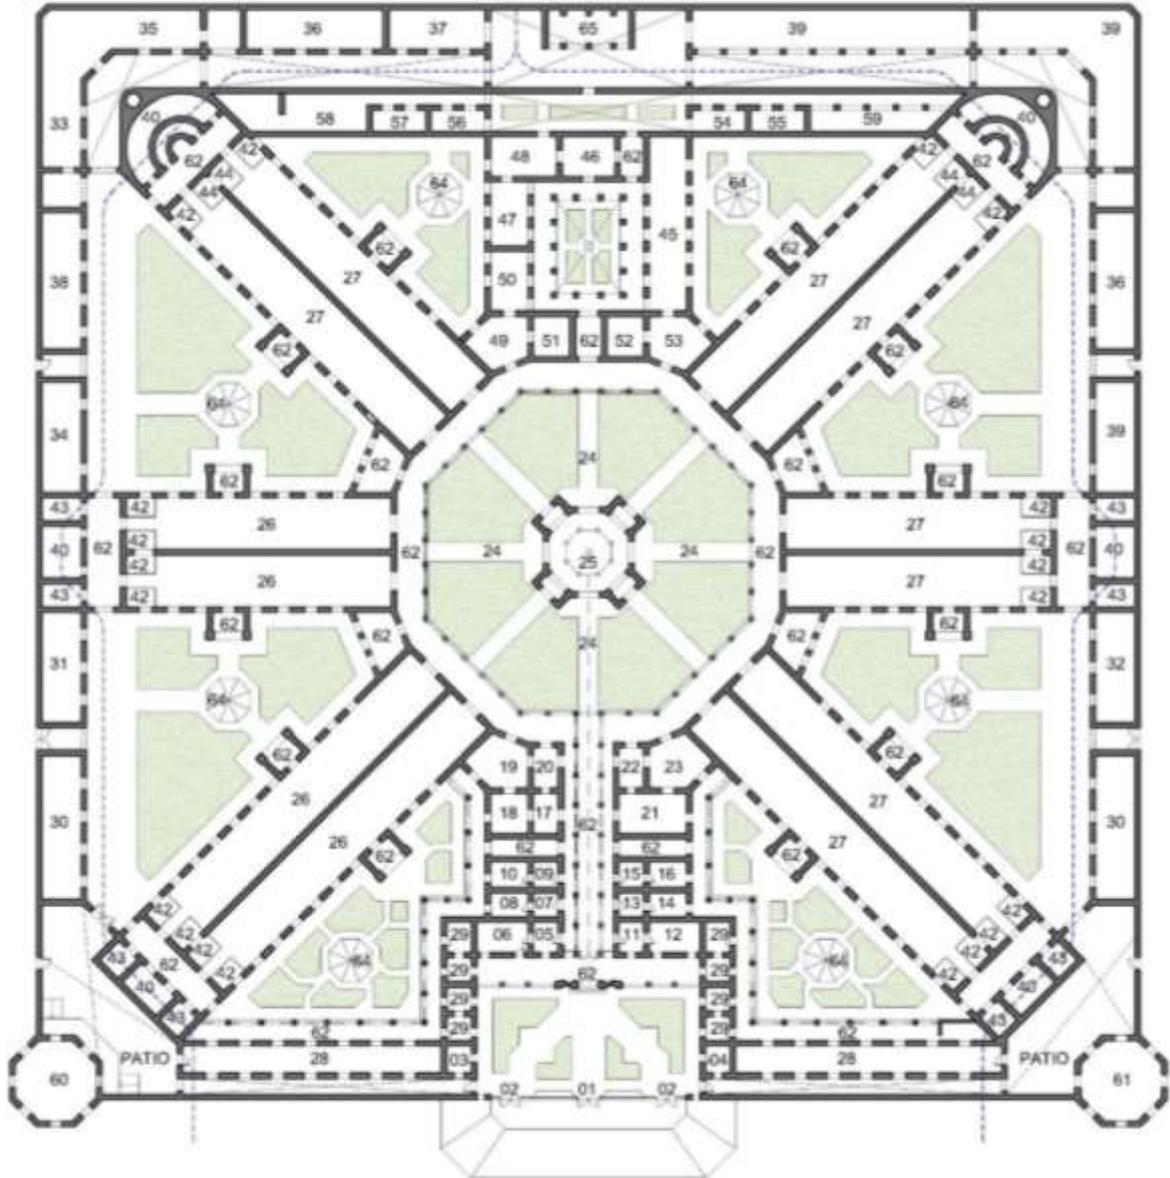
Plano de planta del Hospital Dos de Mayo dibujado por el Autor en base al plano ubicado en L'Universo Illustrato 1869.
